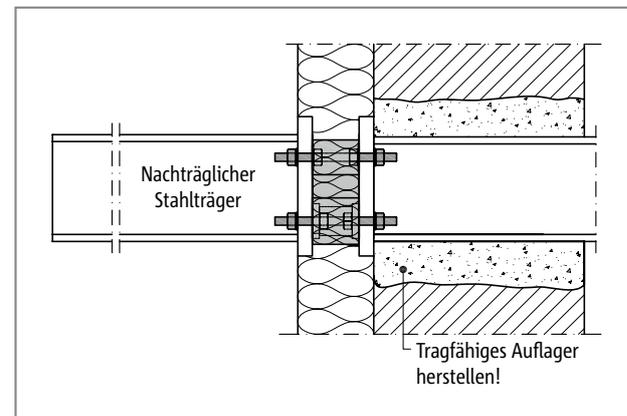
Schöck Isokorb® T Typ S-N und T Typ S-V: nachträglich montierte frei ausragende Stahlkonstruktion; weitere Beispiele zur Sanierung siehe S.178
